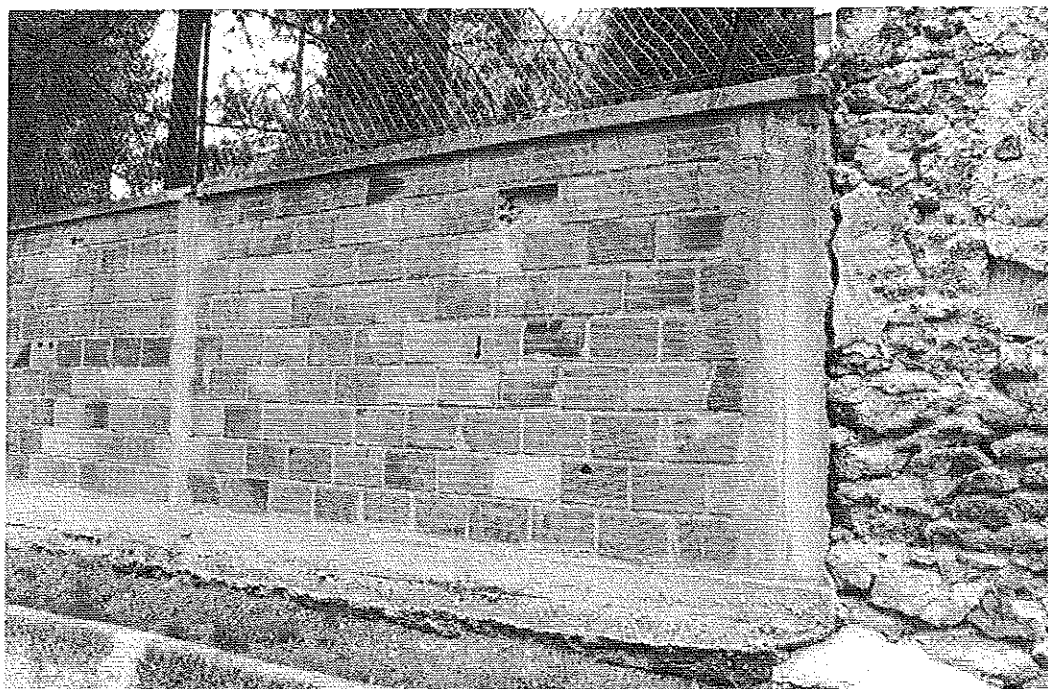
Raccordement du mur de clôture avec le mur pignon. Fissure de rupture. Déchaussement de la fondation. © J. Putatti
